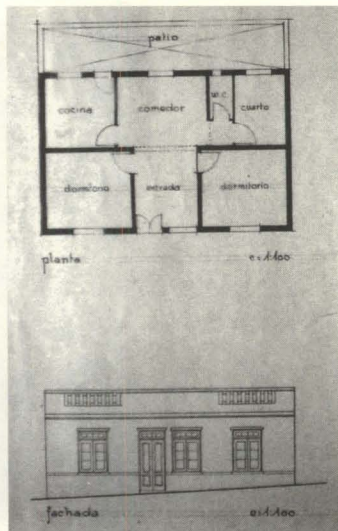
Casa para d. H. Pilkington en la calle de S. Telmo. Planta y alzado, 1935.
